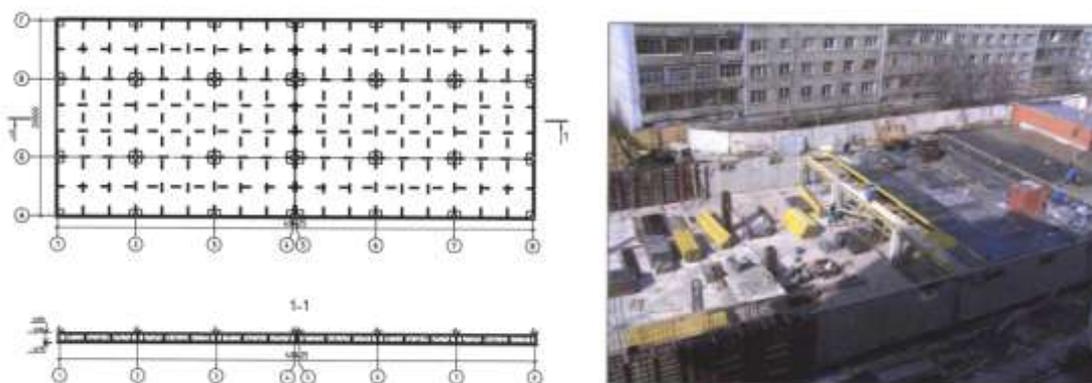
Фундамент (ПФП) и здание гаража-стоянки
